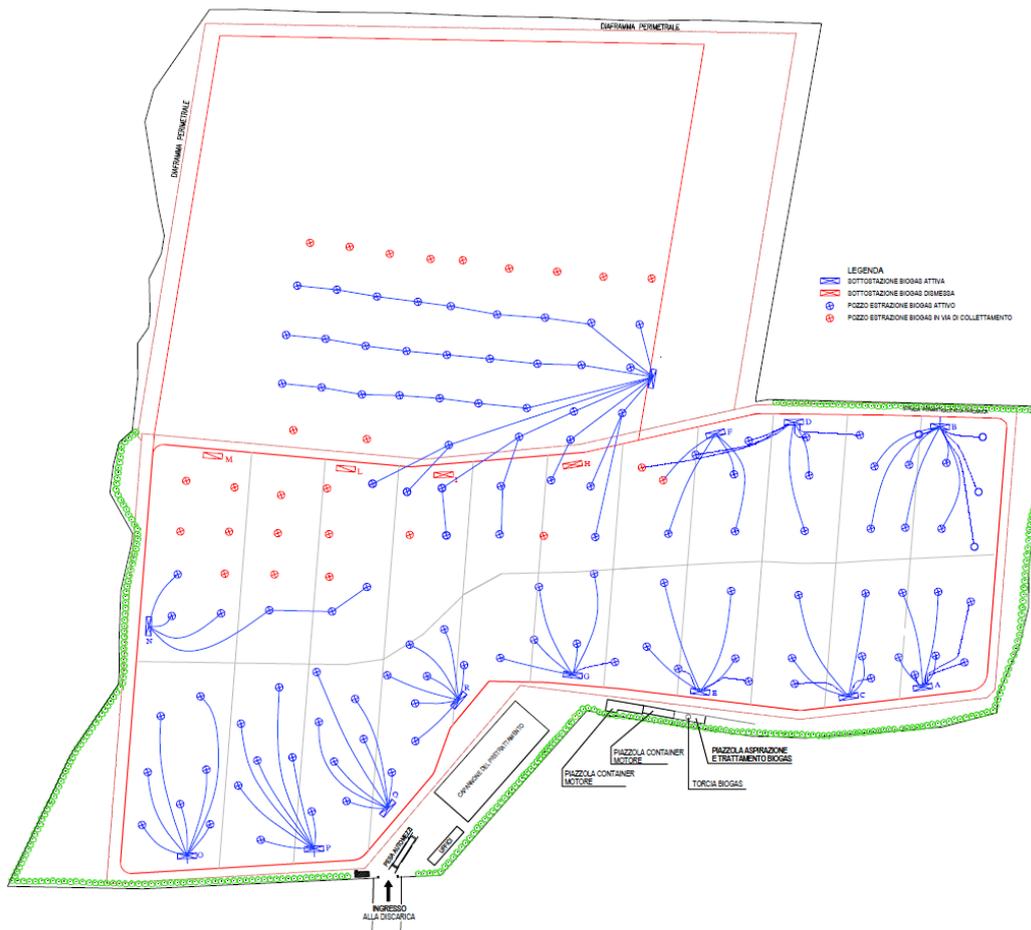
Planimetria stato di fatto impianto di captazione biogas al 30/12/2018
